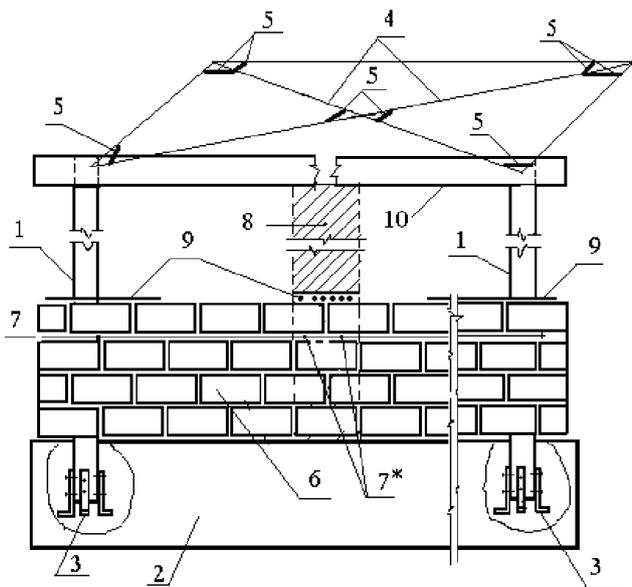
Схема антисейсмических мероприятий при строительстве сейсмостойкого дома со стенами из глиняных саманных блоков. 1- деревянная стойка; 2- бетонный ленточный фундамент; 3- металлические накладки; 4- диагональные раскосы; 5- скобы; 6- кладка из саманных блоков; 7- армирование из полимерной сетки; 7*- то же примыкающих стен; 8- примыкающая стена; 9 - армирование камышом (углов, примыкающих стен, пересечений стен); 10- элемент обвязки кровли.
